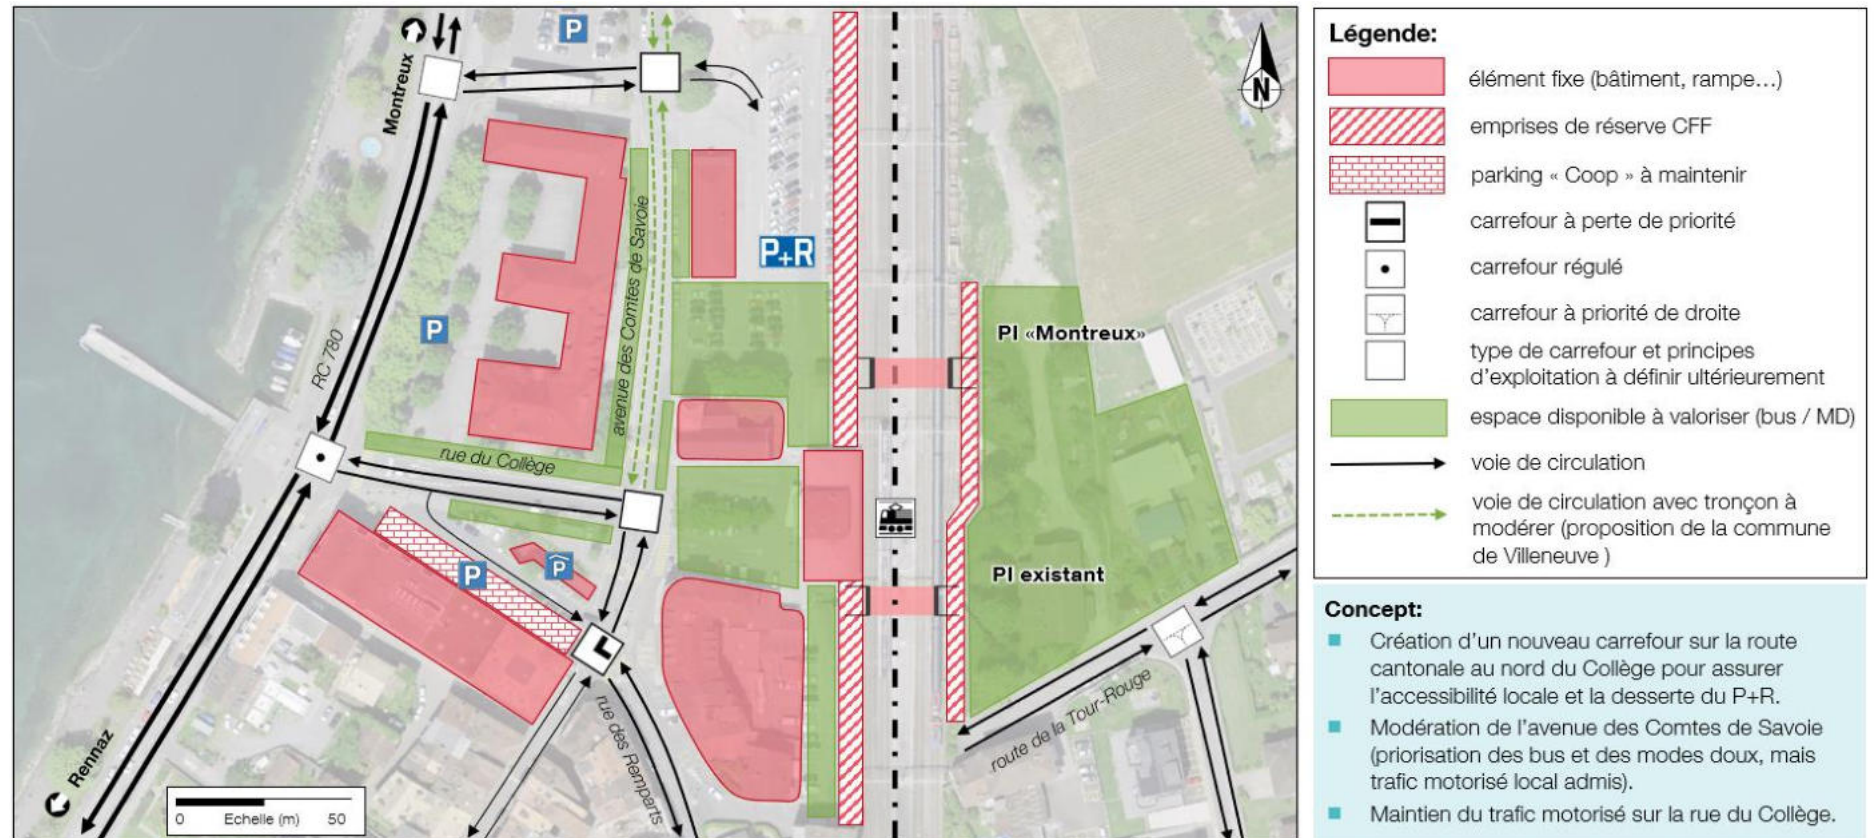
Plan de circulation retenu pour le secteur de la gare
